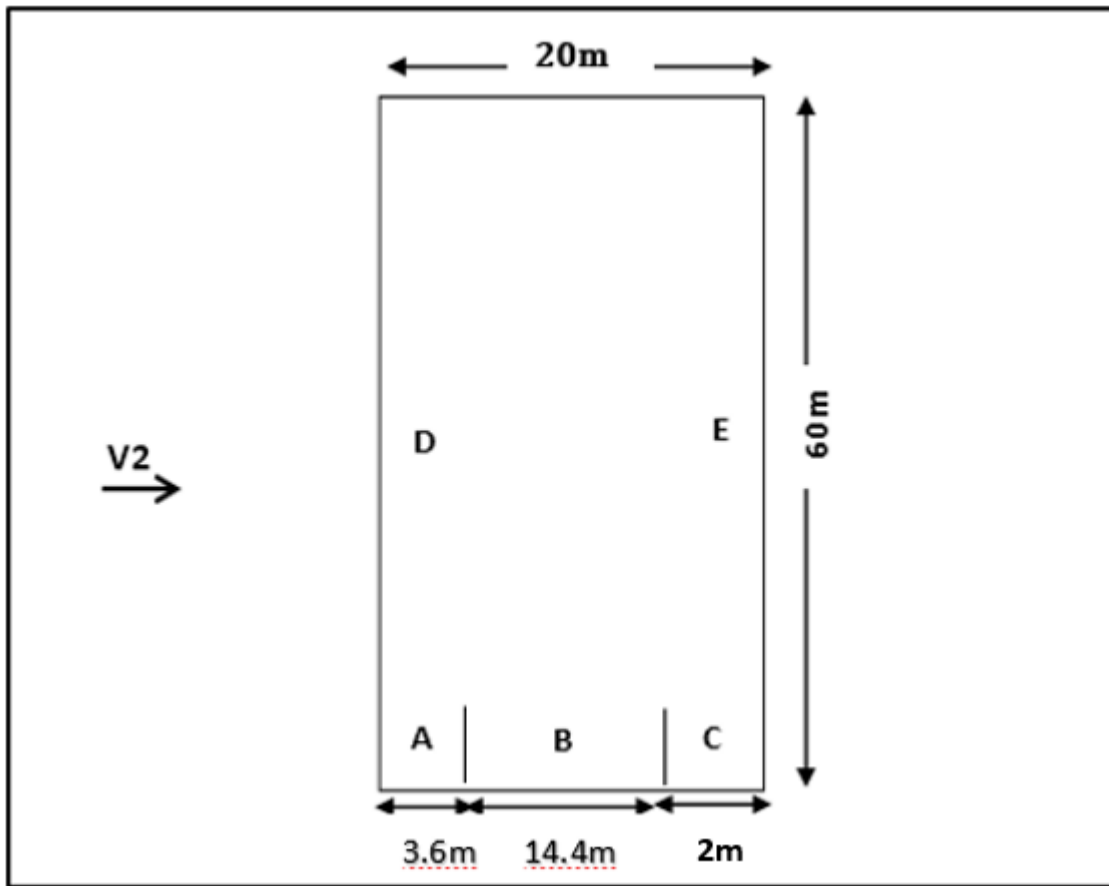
Vue en plan des zones de pression sur les parois verticales sens V_2 .
